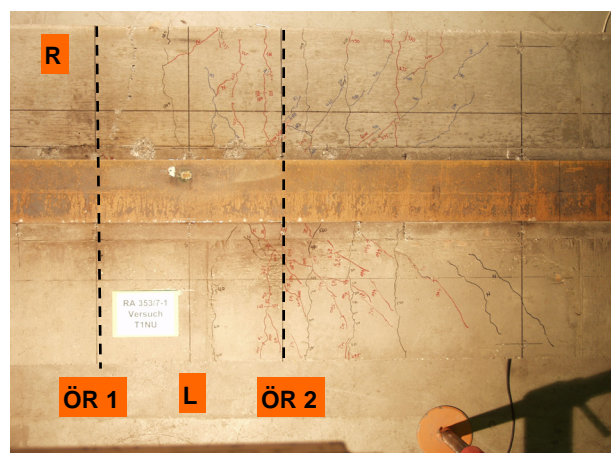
Rissbild auf der Betongurtunterseite
